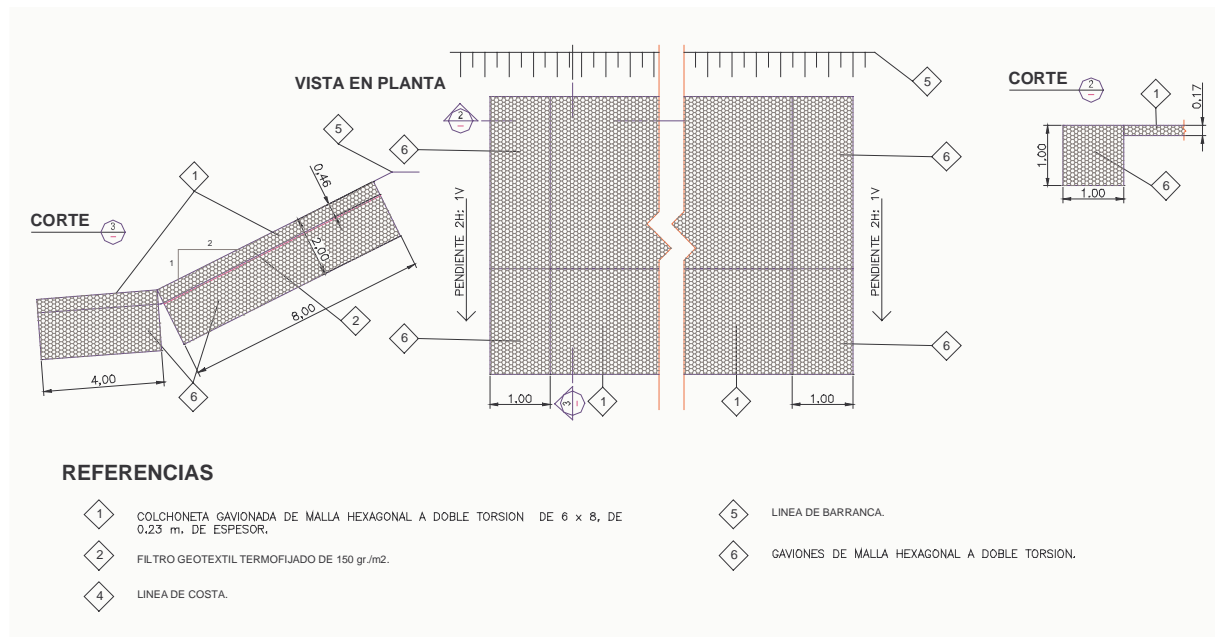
Detalle de “empotramiento” de la obra de colchonetas
